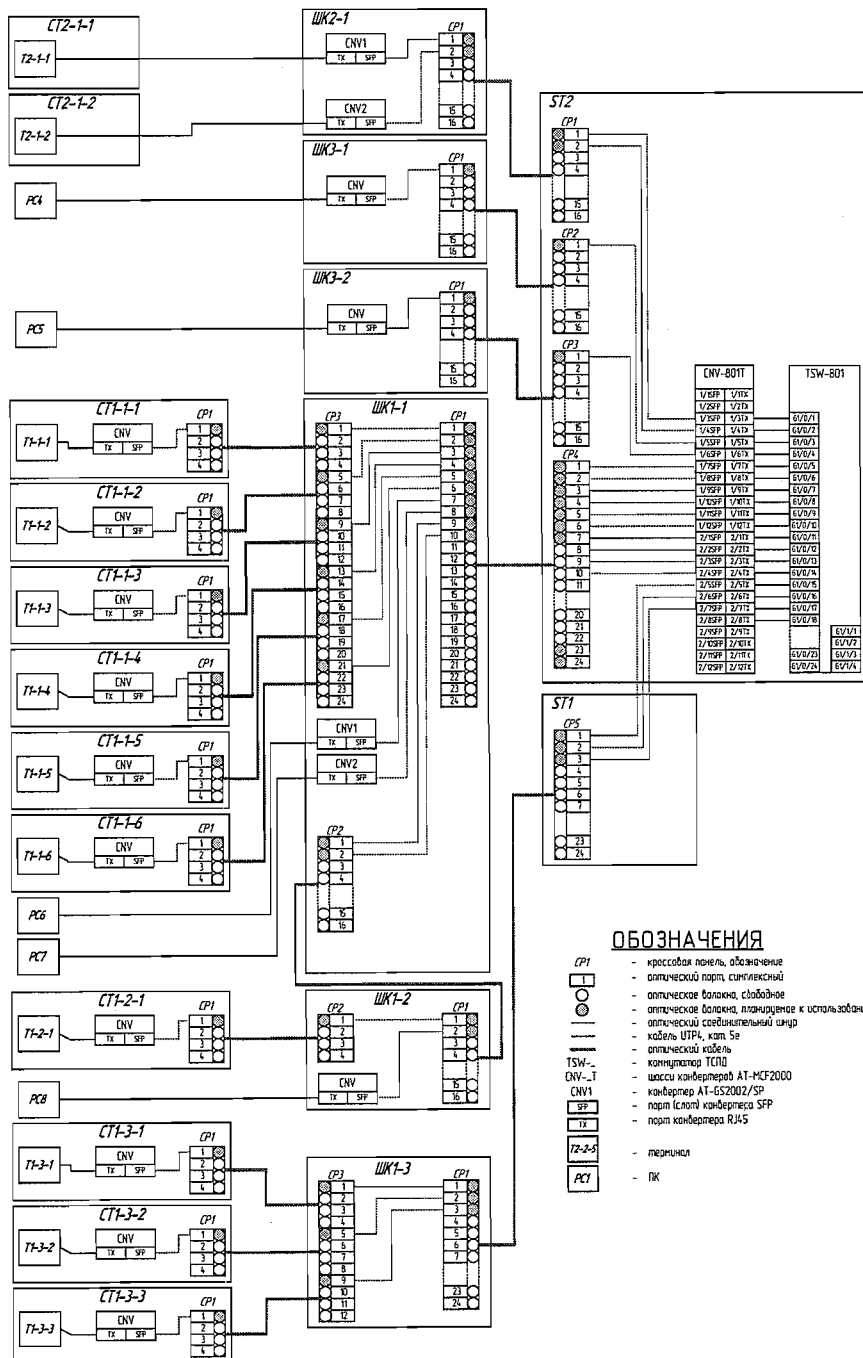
Схема соединений СОУП60 в корпусе 801.
